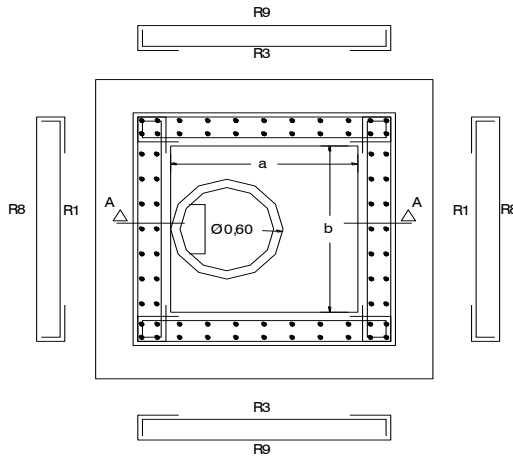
Caja elementos control perdida concreto reforzado
